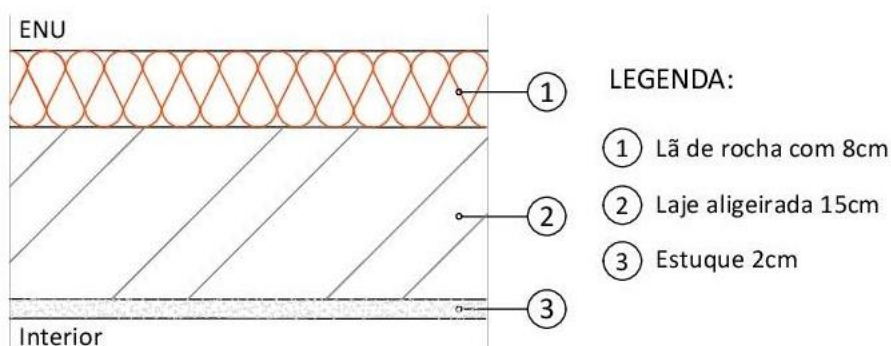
Pormenor construtivo da cobertura interior
